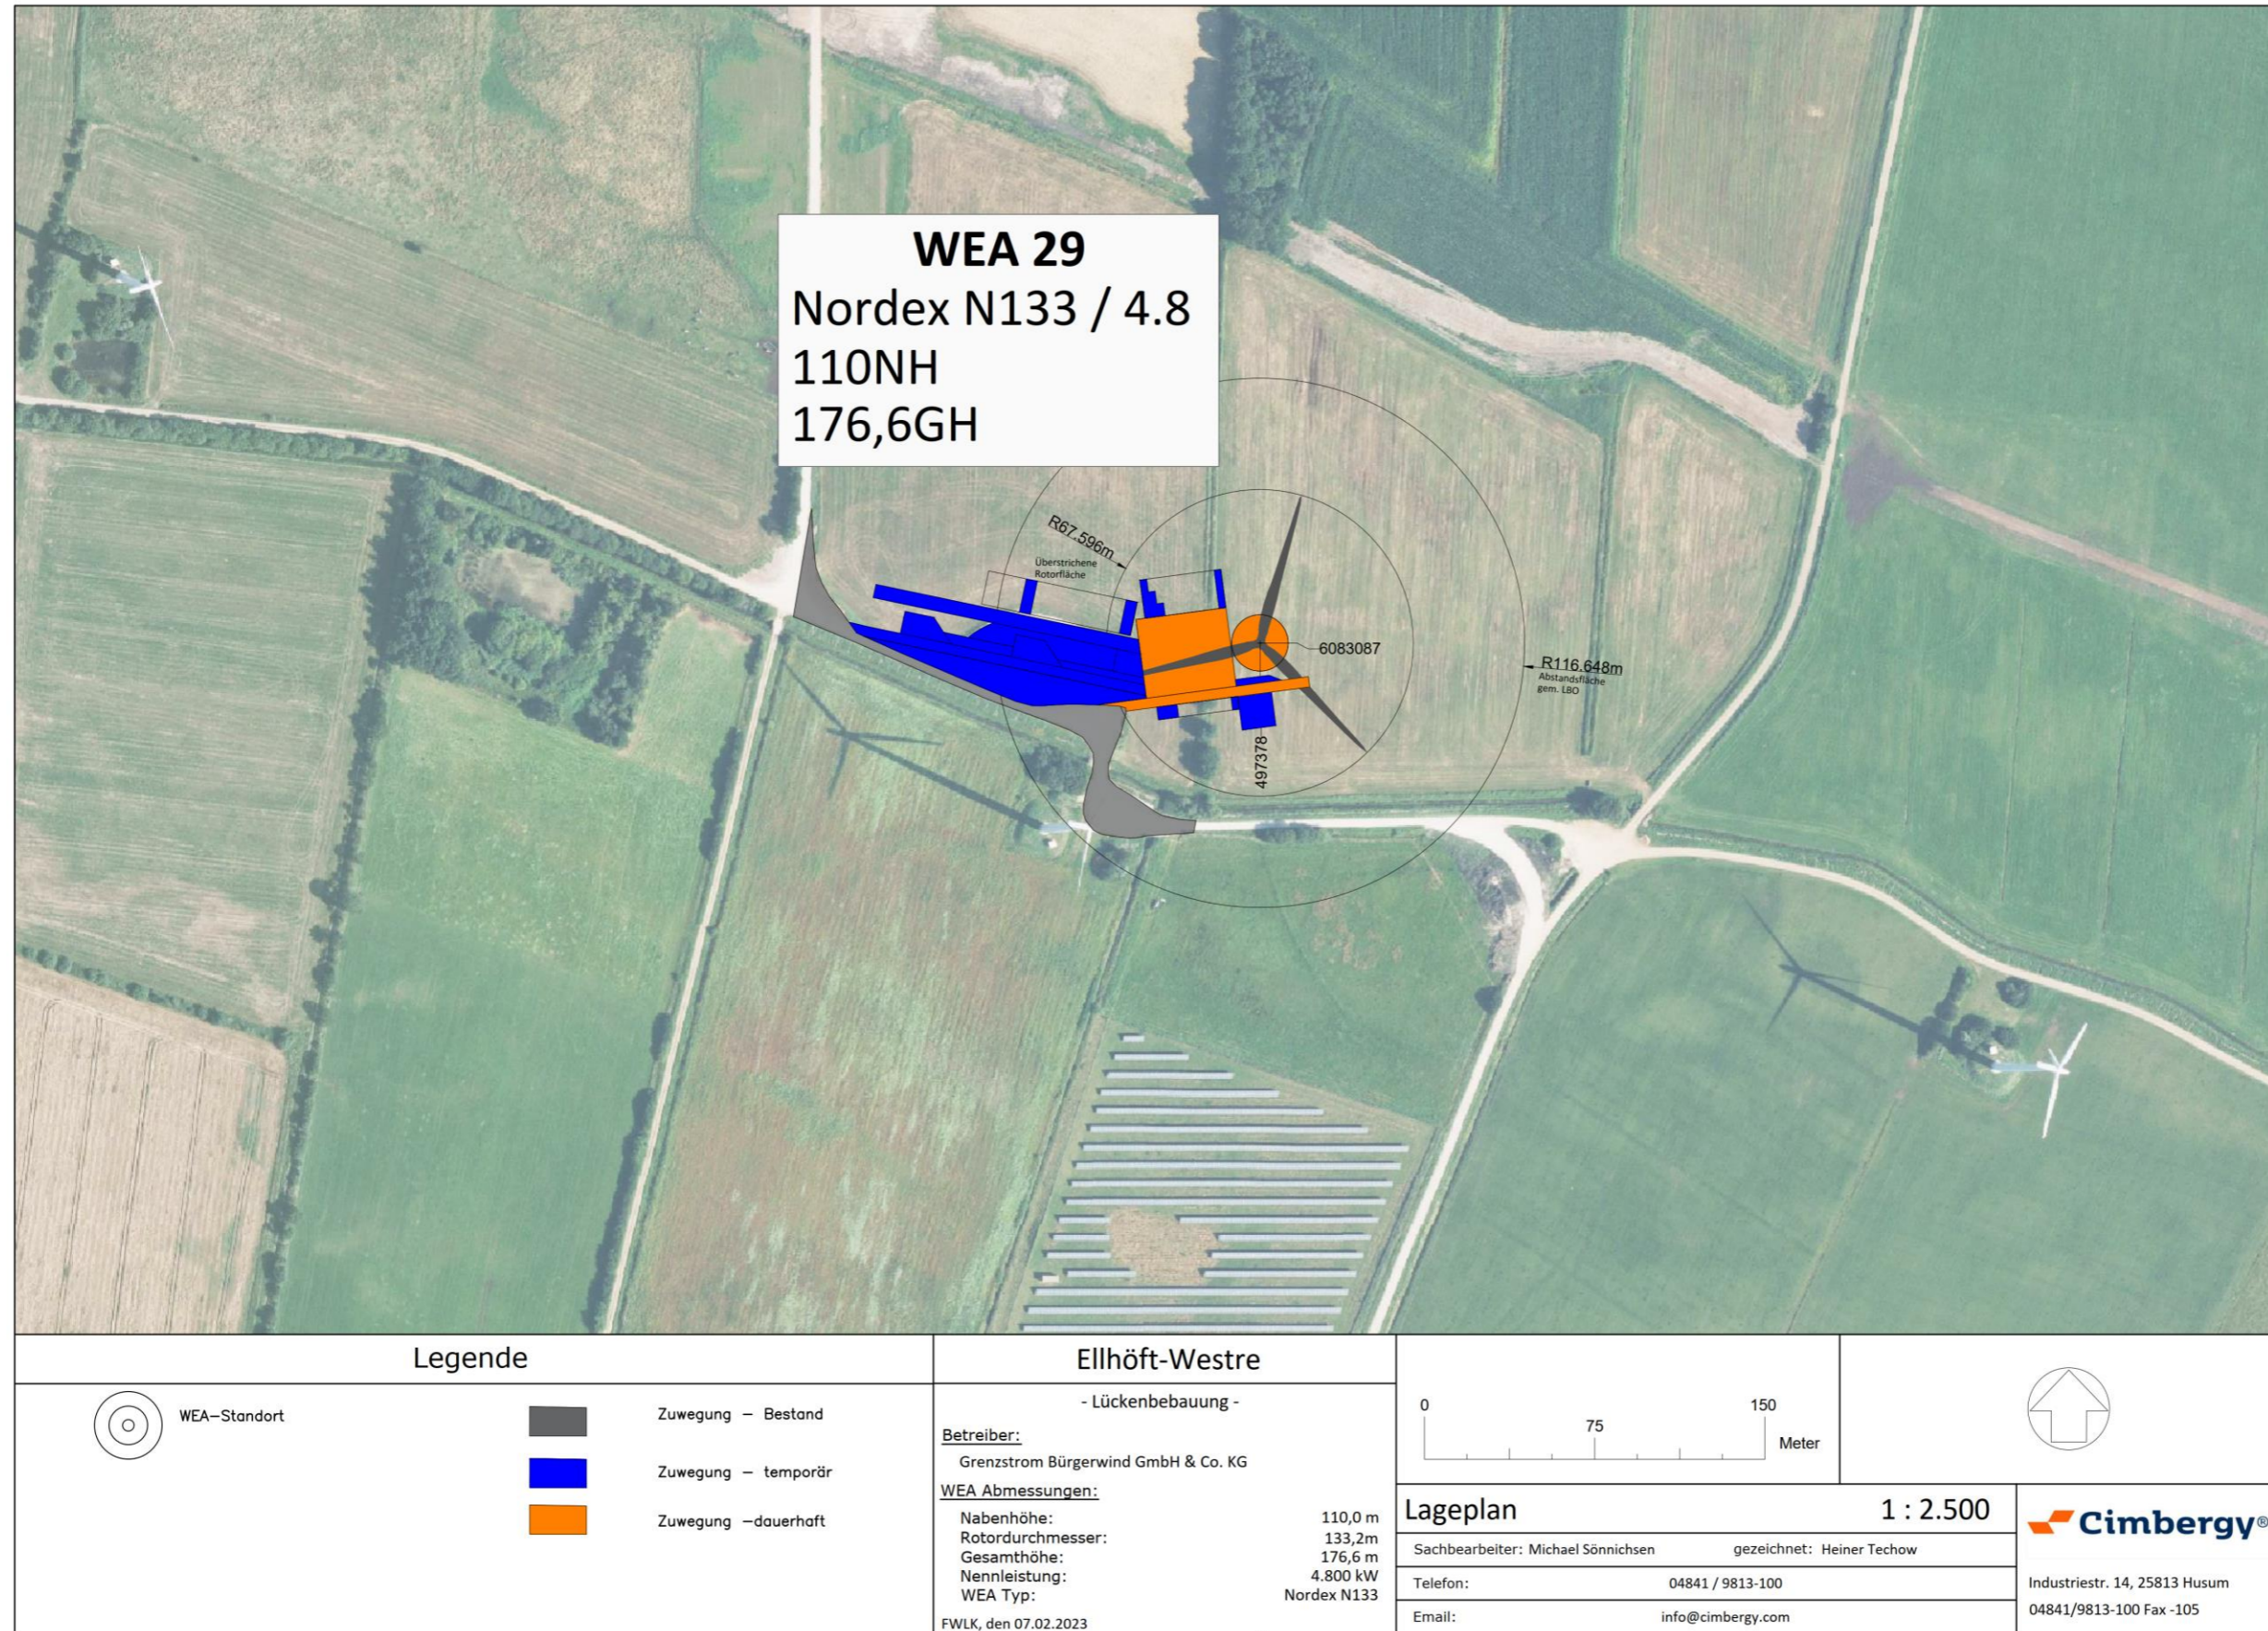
Planlægning af placering og adgang VEA 29 (Kilde: Cimbergy; sidst ændret: 08-02-2023)
